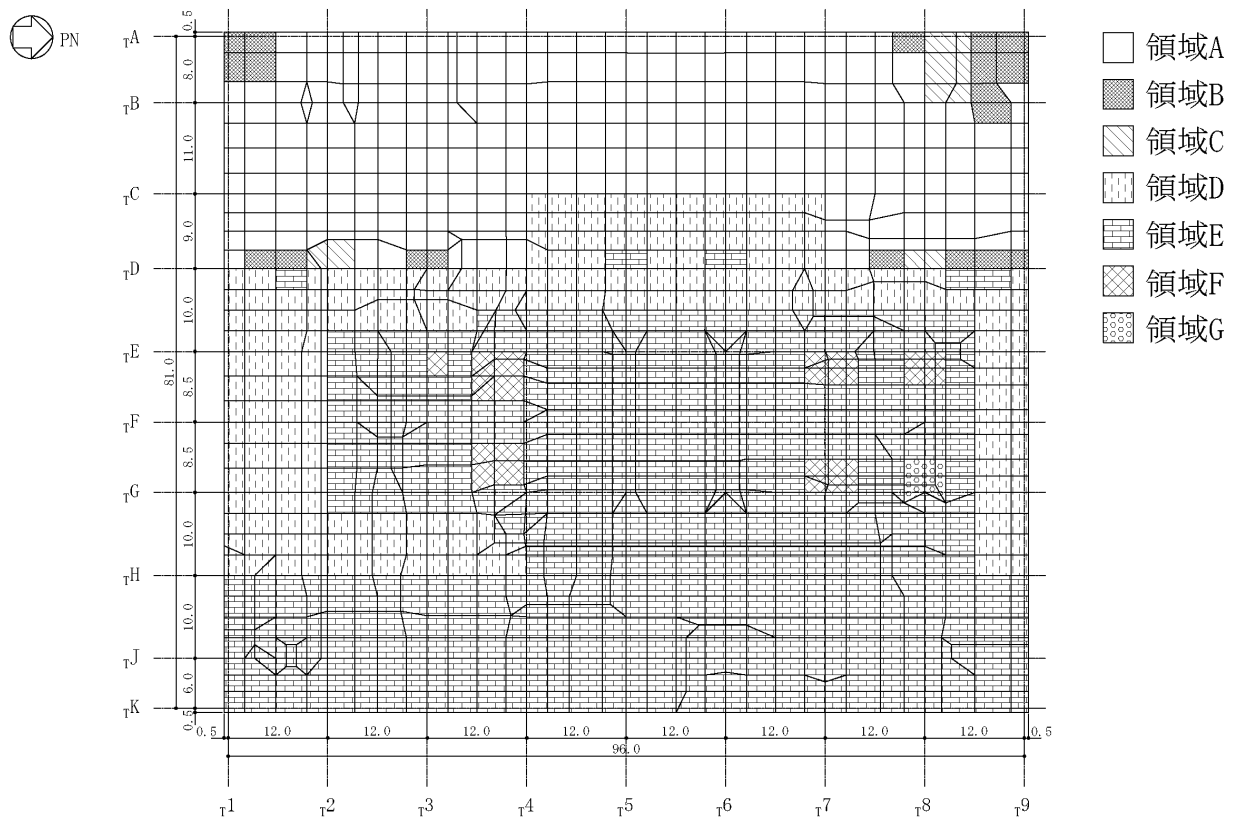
基礎スラブの配筋領域図 (EW 方向, 下ば筋) (単位 : m)
